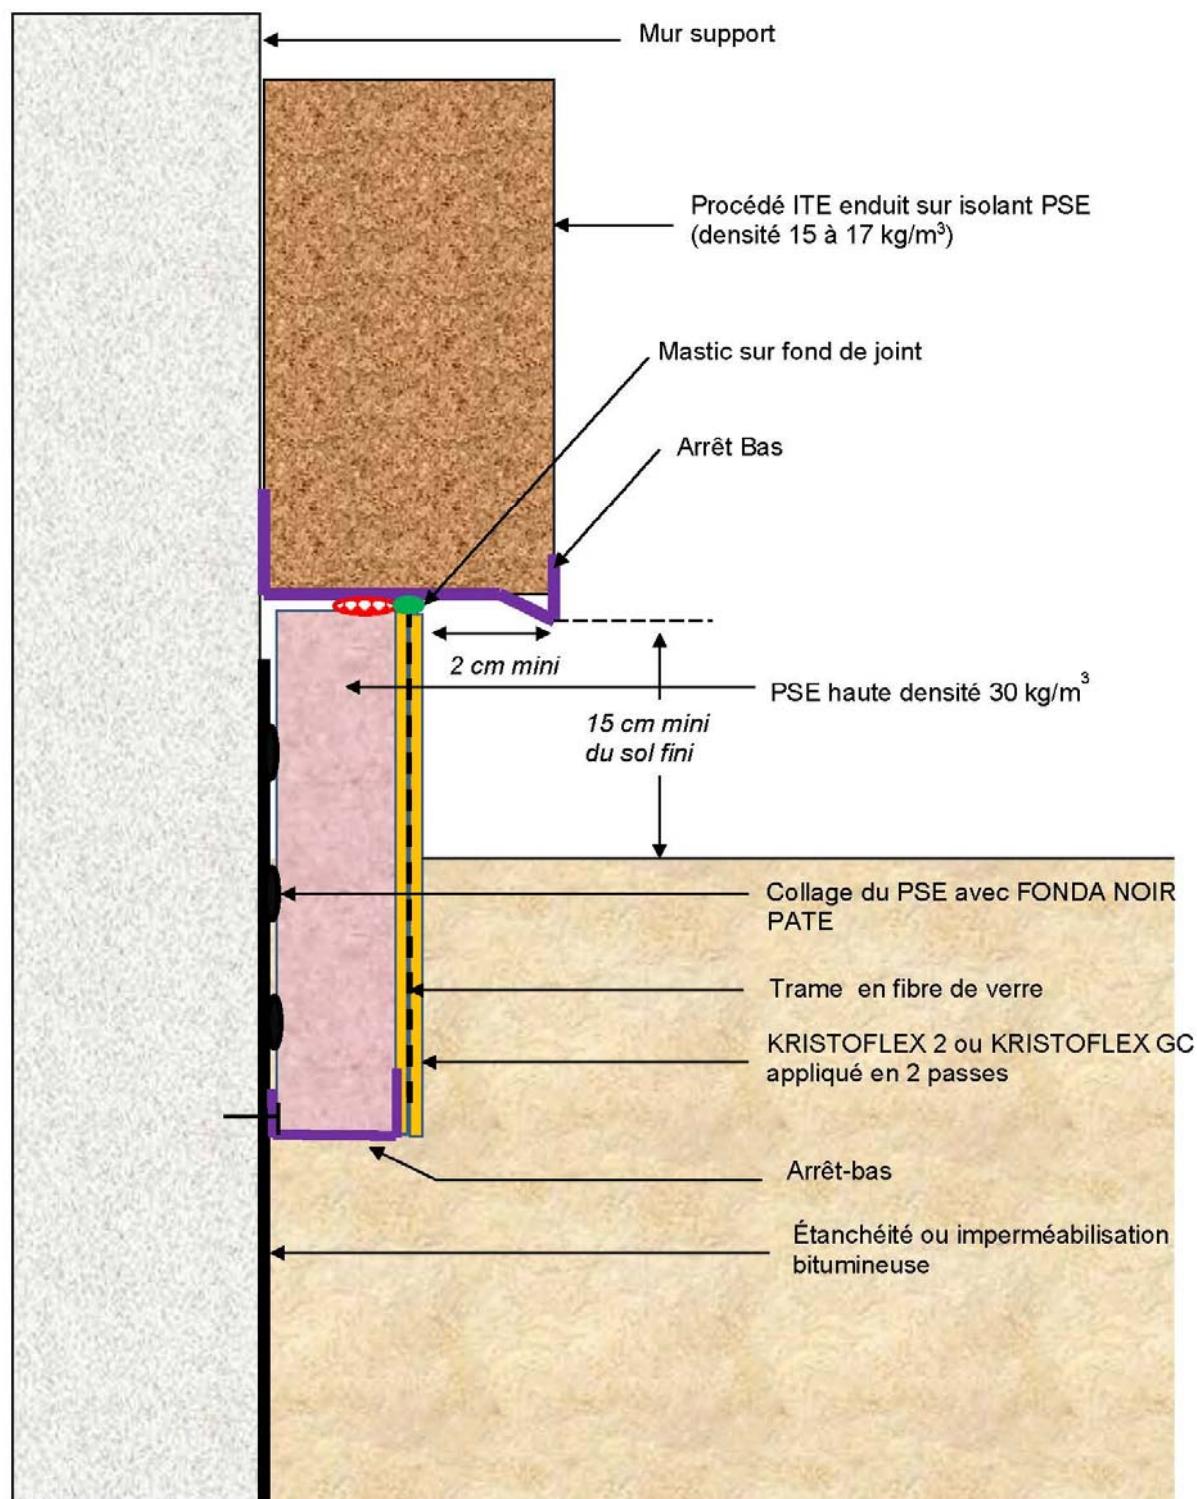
Départ en partie semi-enterrée : cas d'une paroi revêtue d'un enduit bitumineux
